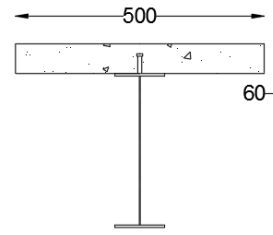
Secção tipo da viga do ensaio MI 1
